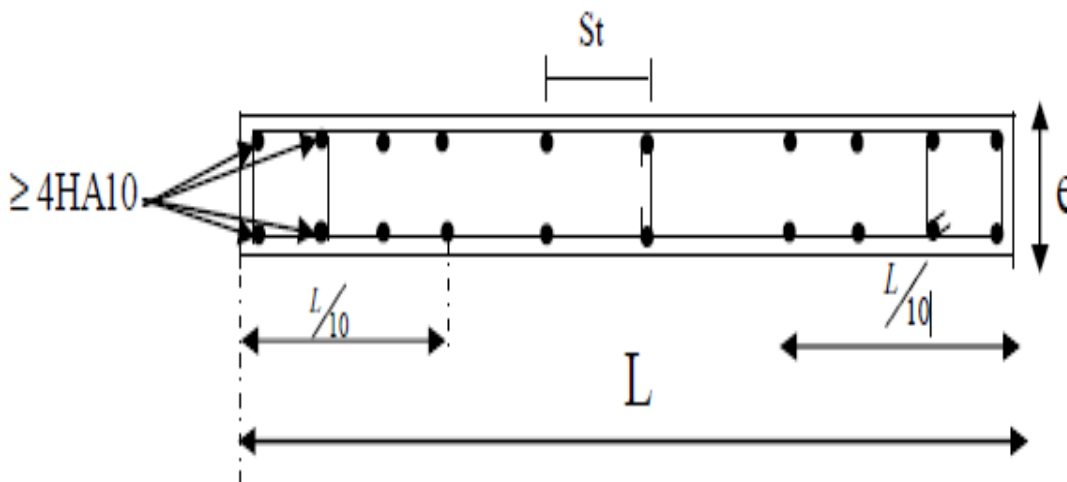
Disposition des armatures verticales dans les voiles
